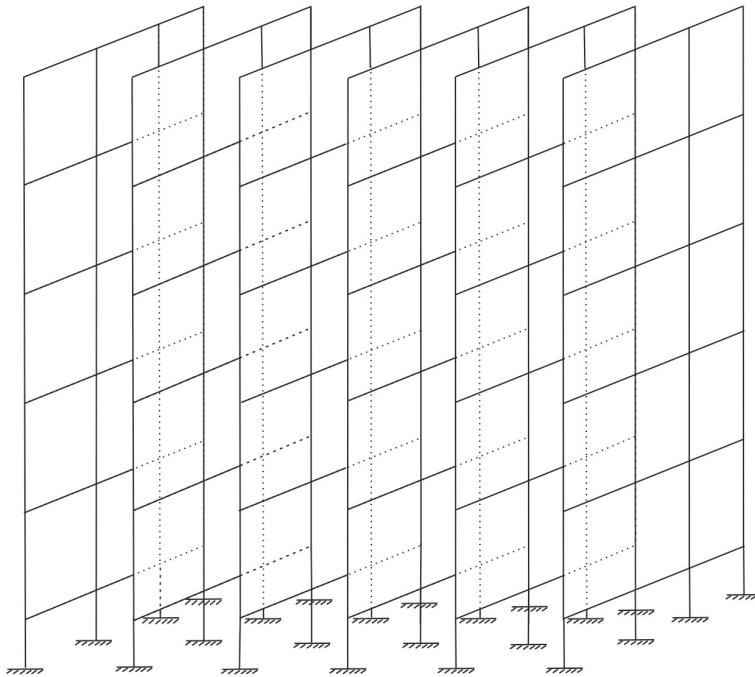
Конструктивная схема каркаса многоэтажного здания из железобетона
